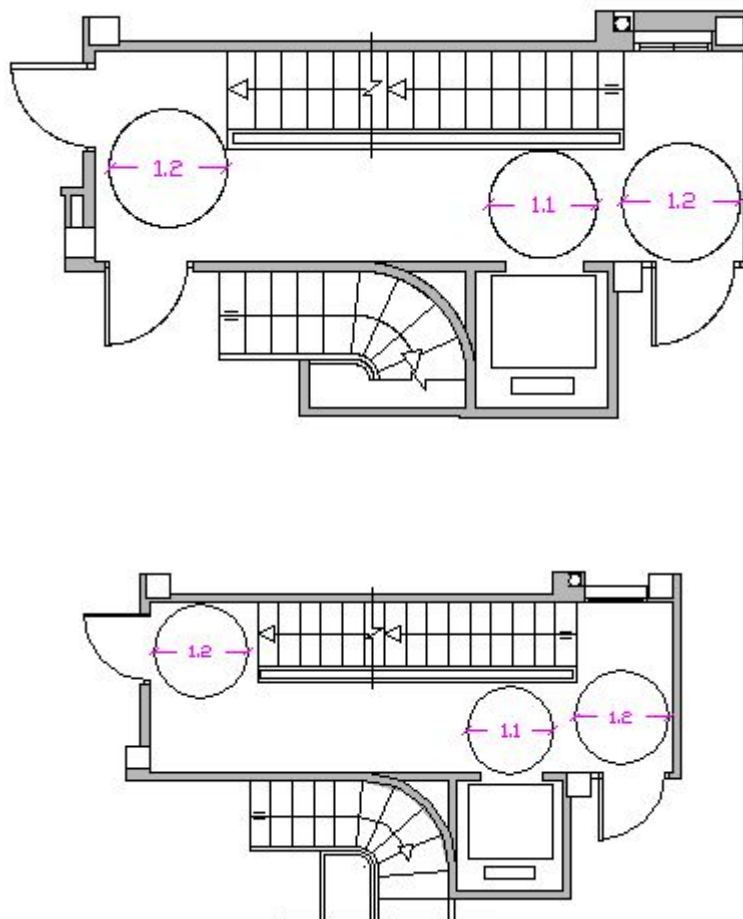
Accesibilidad plantas de vivienda [Anexo II. Planos]
